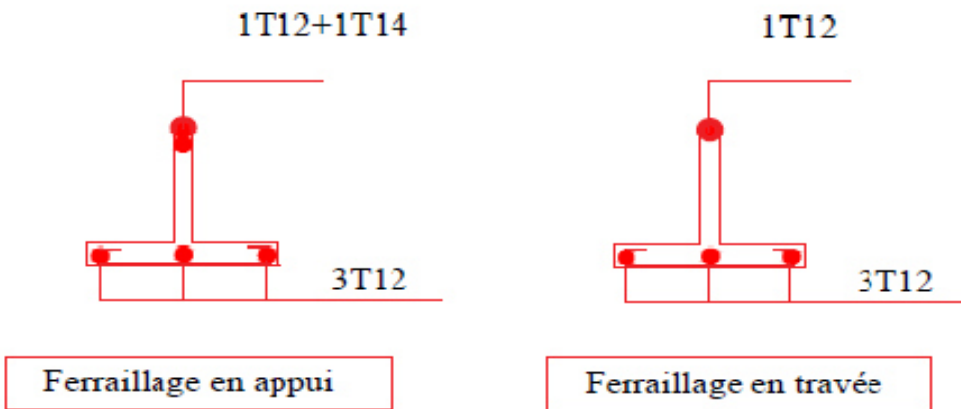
Schéma de ferrailage de la poutrelle.
